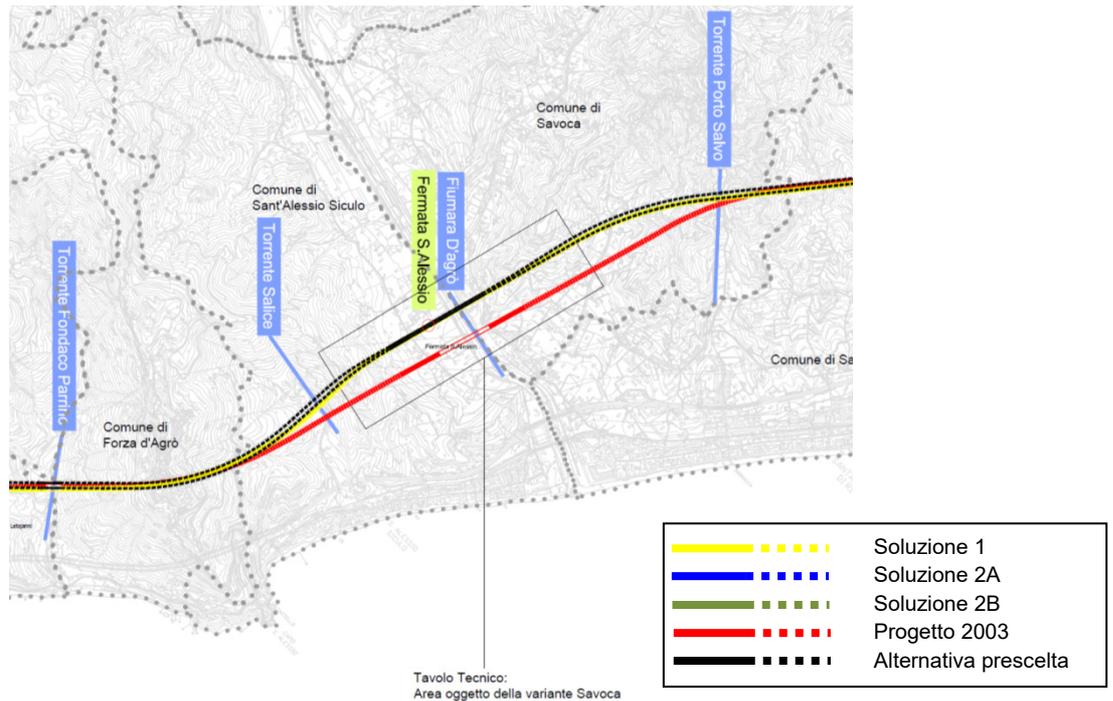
Tavolo Tecnico Variante planimetrica S. Alessio S. – Savoca
